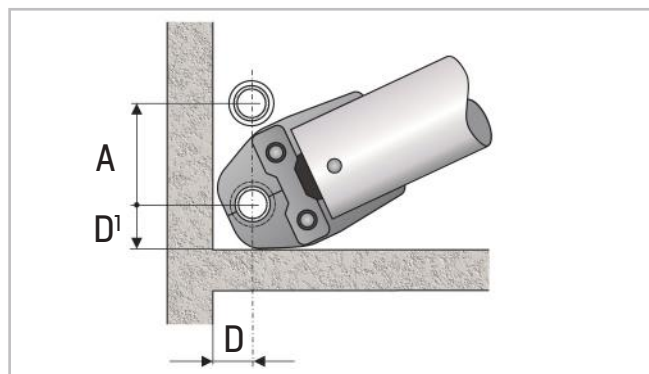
Minimale plaatsingsafstanden voor persbek/ketting
